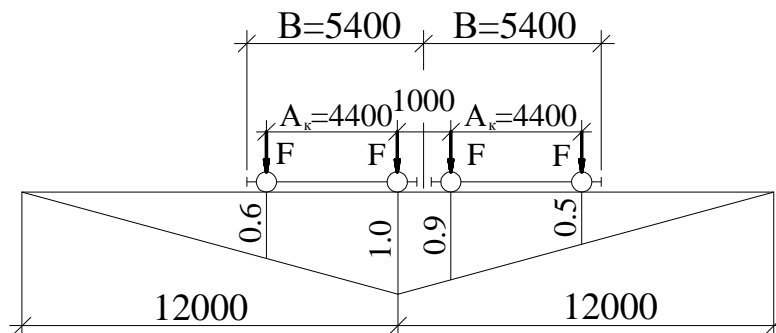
Схема до розрахунку колони на кранове навантаження
